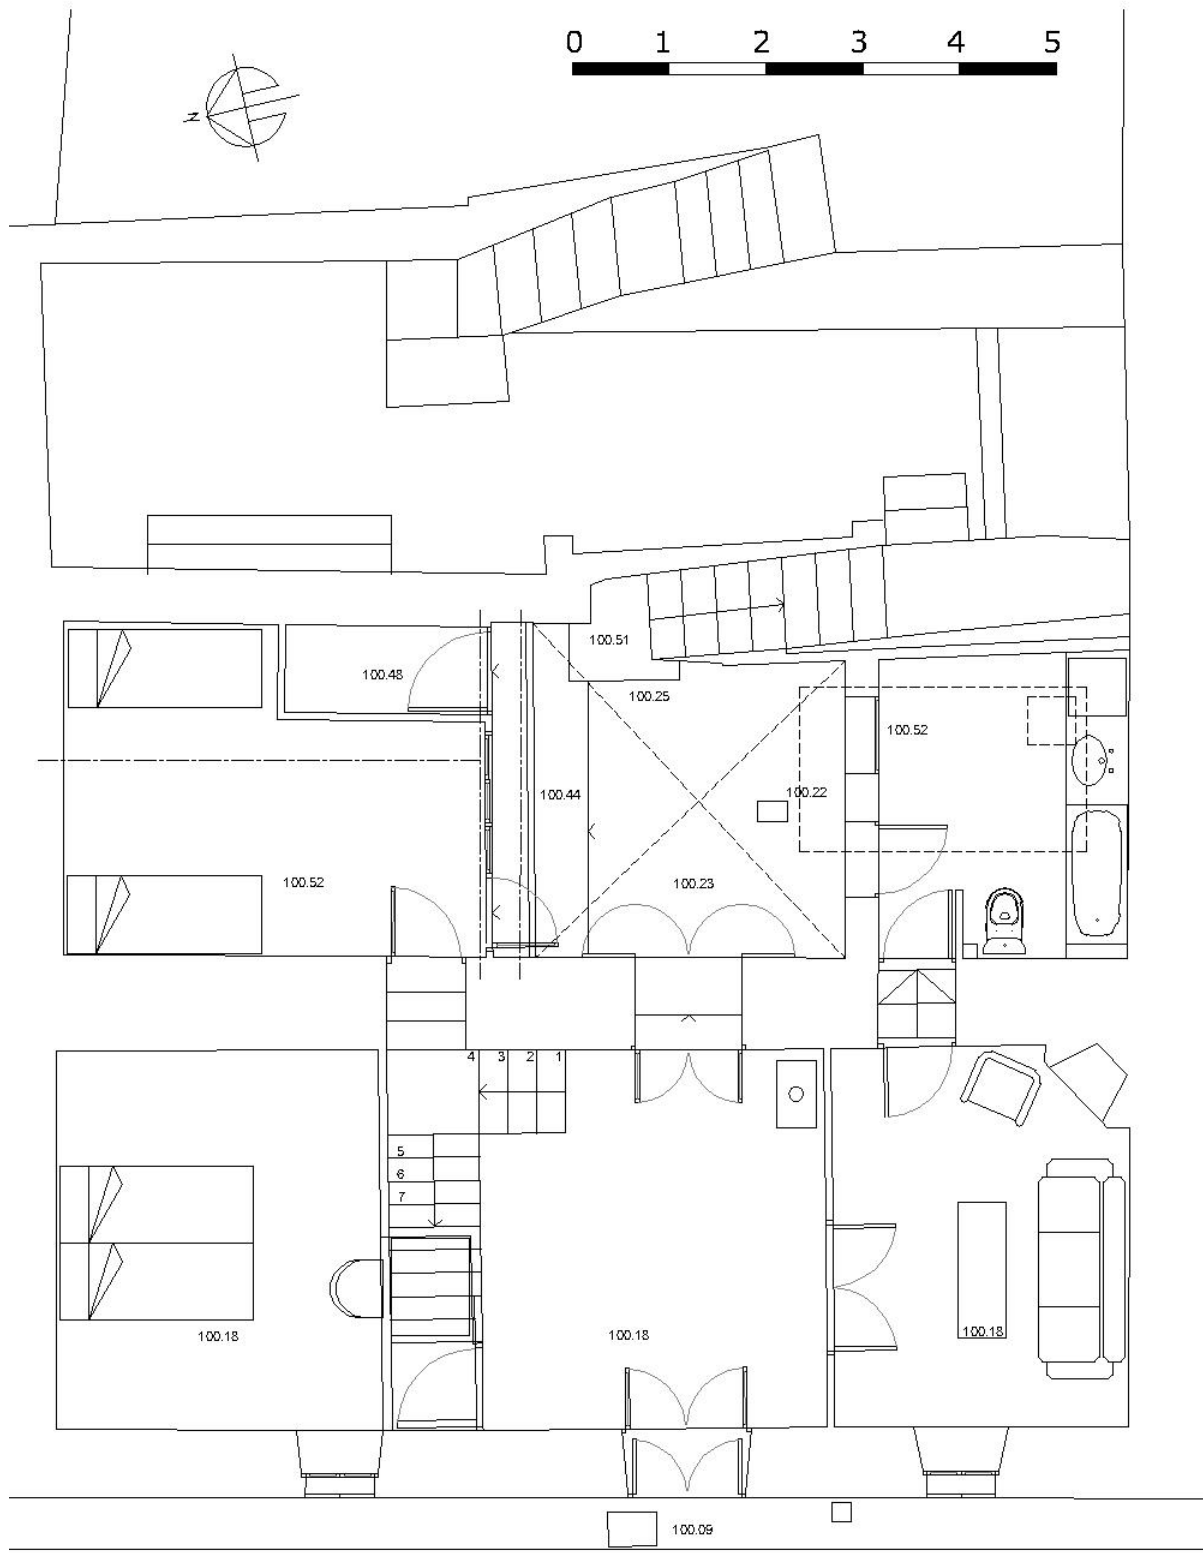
Propuesta de ampliación de la vivienda. Distribución de planta baja
